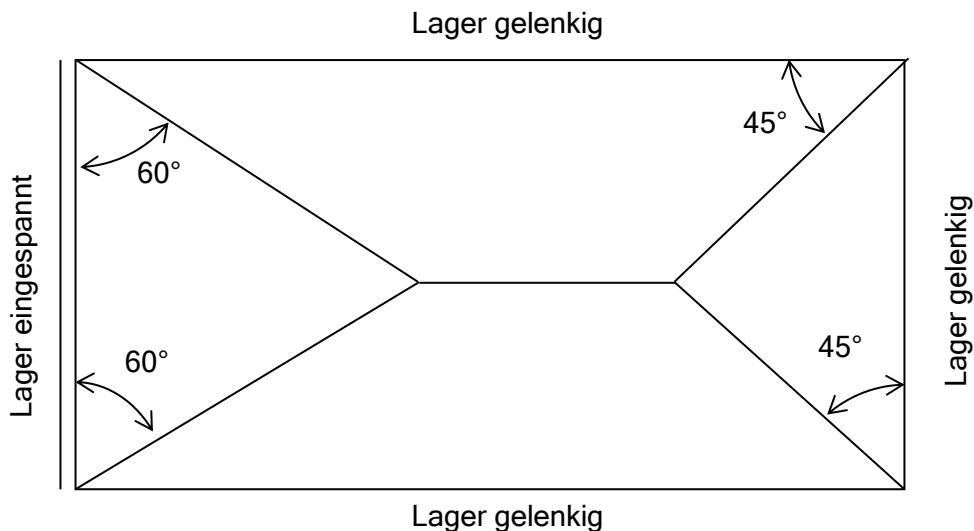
Ermittlung der Deckenauflagerkräfte bei zweiachsig gespannten Decken
